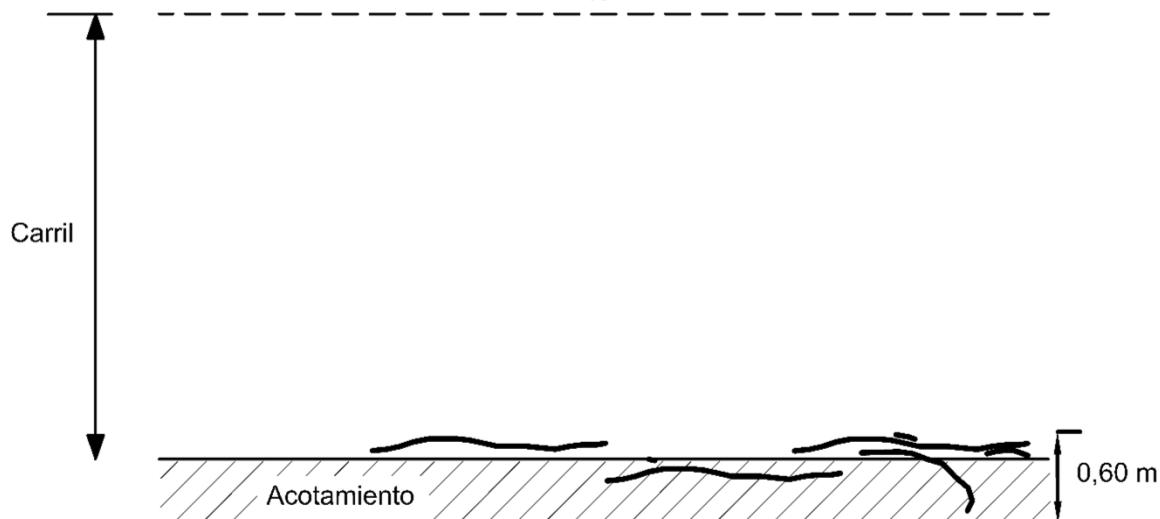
Esquema del deterioro "grieta de borde" (vista en planta)
